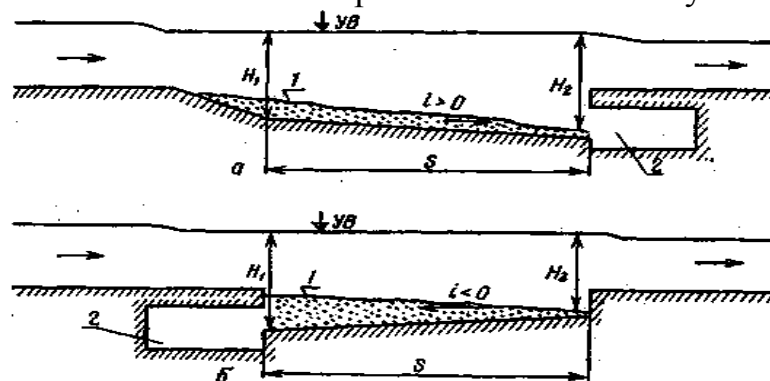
Схемы отстойников (продольный разрез):
